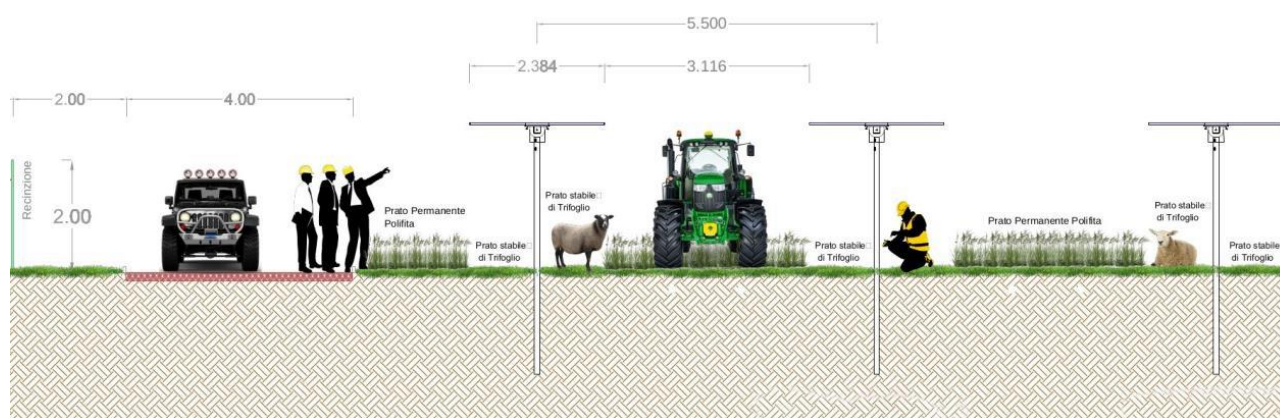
Schema di impianto e disposizione del prato permanente stabile
